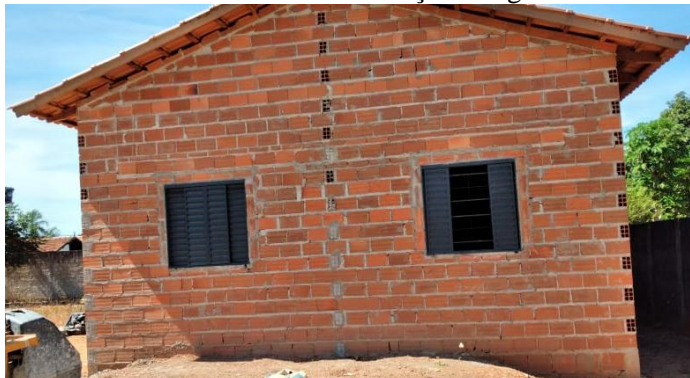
Fachada da casa D em construção – registro em 14/02/2020.
